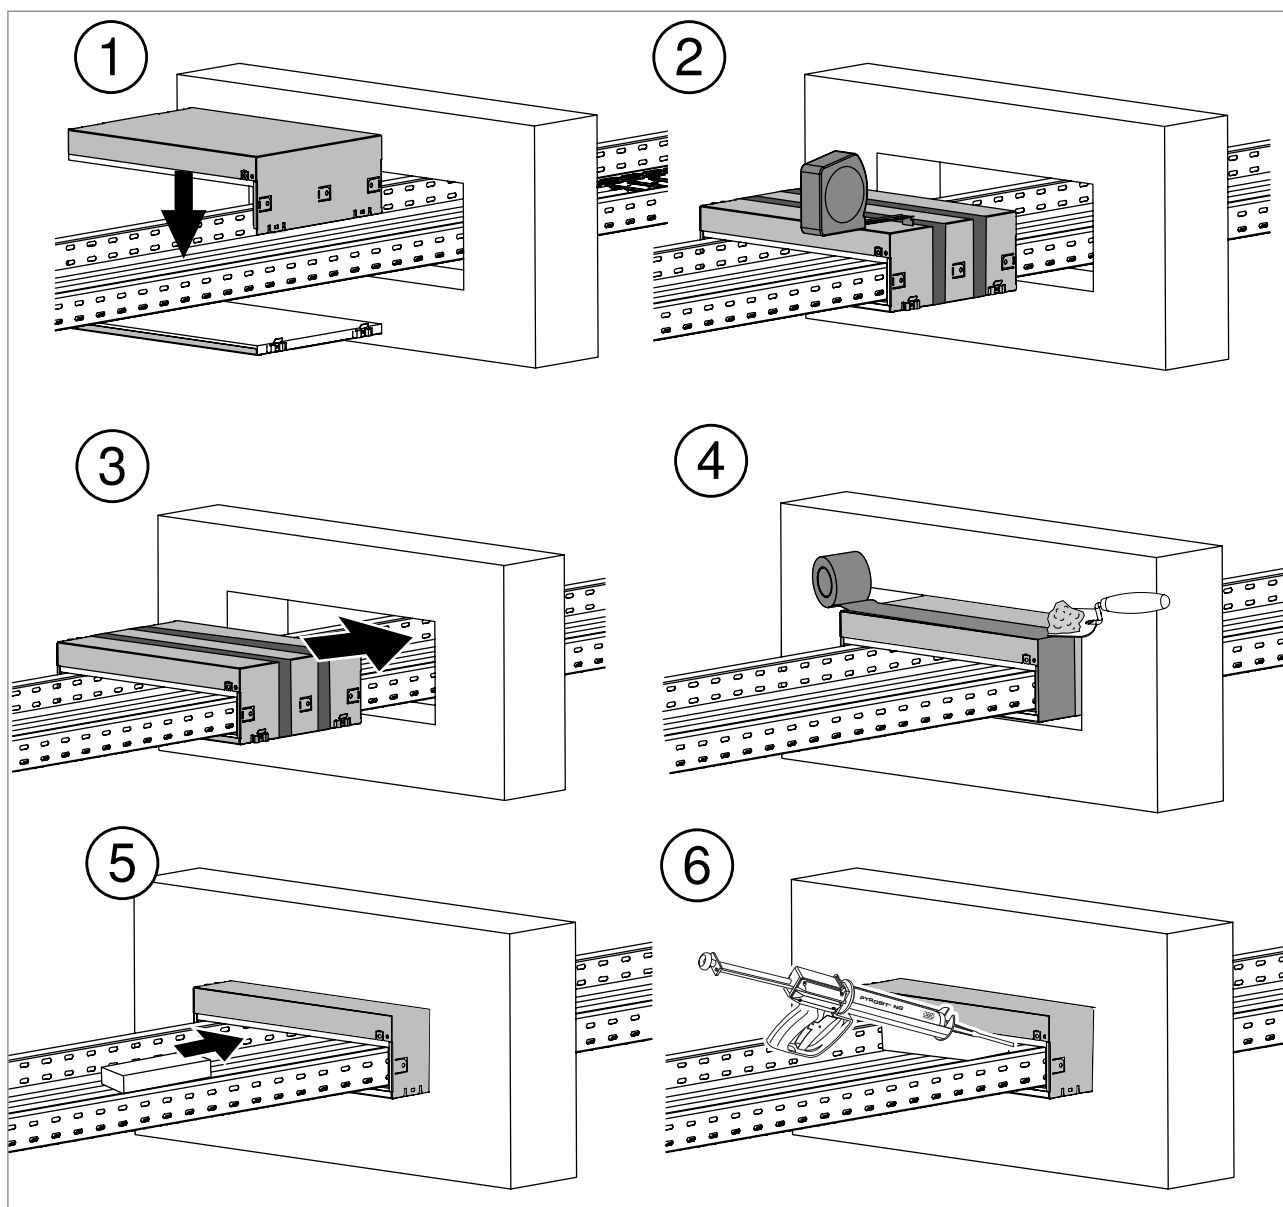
Mounting the 4-sided PYROPLUG® MagicBox (wall mounting)
